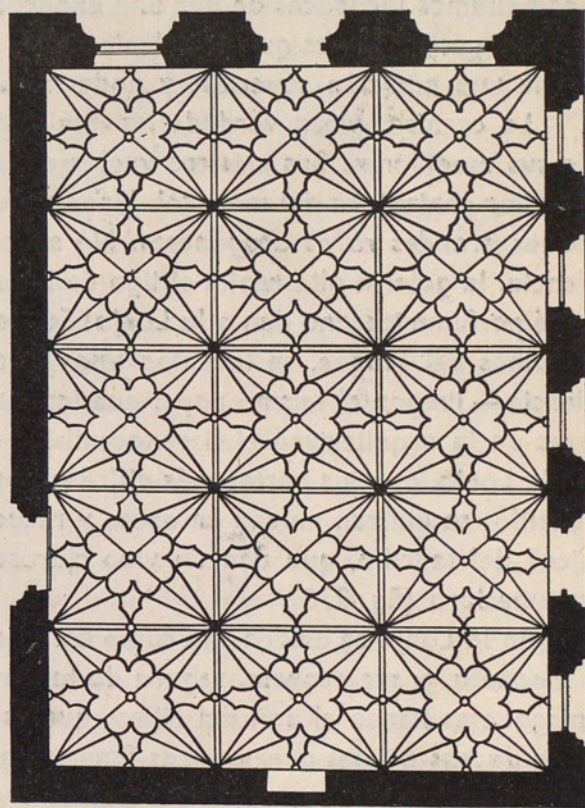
PLANTA DE LA LONJA DE ZARAGOZA.
